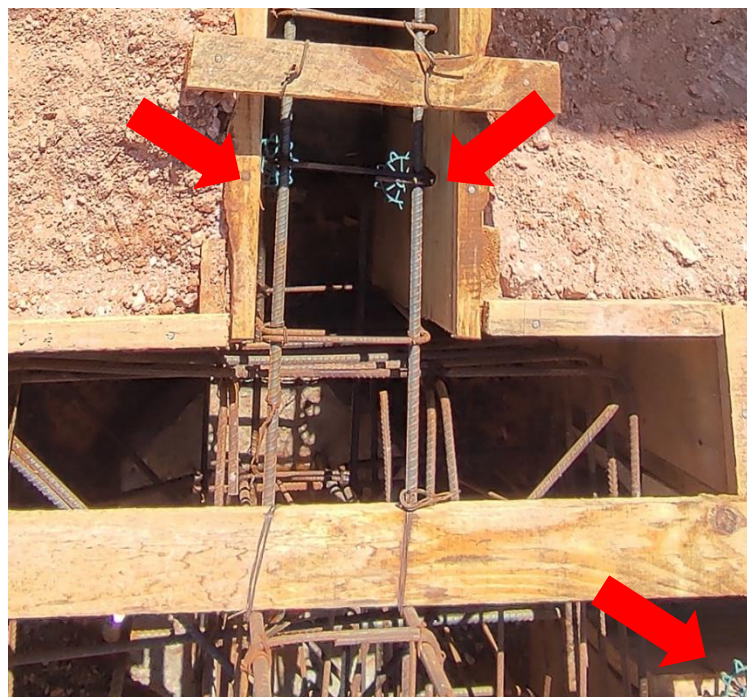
Execução das formas das vigas baldrame e blocos de coroamento
